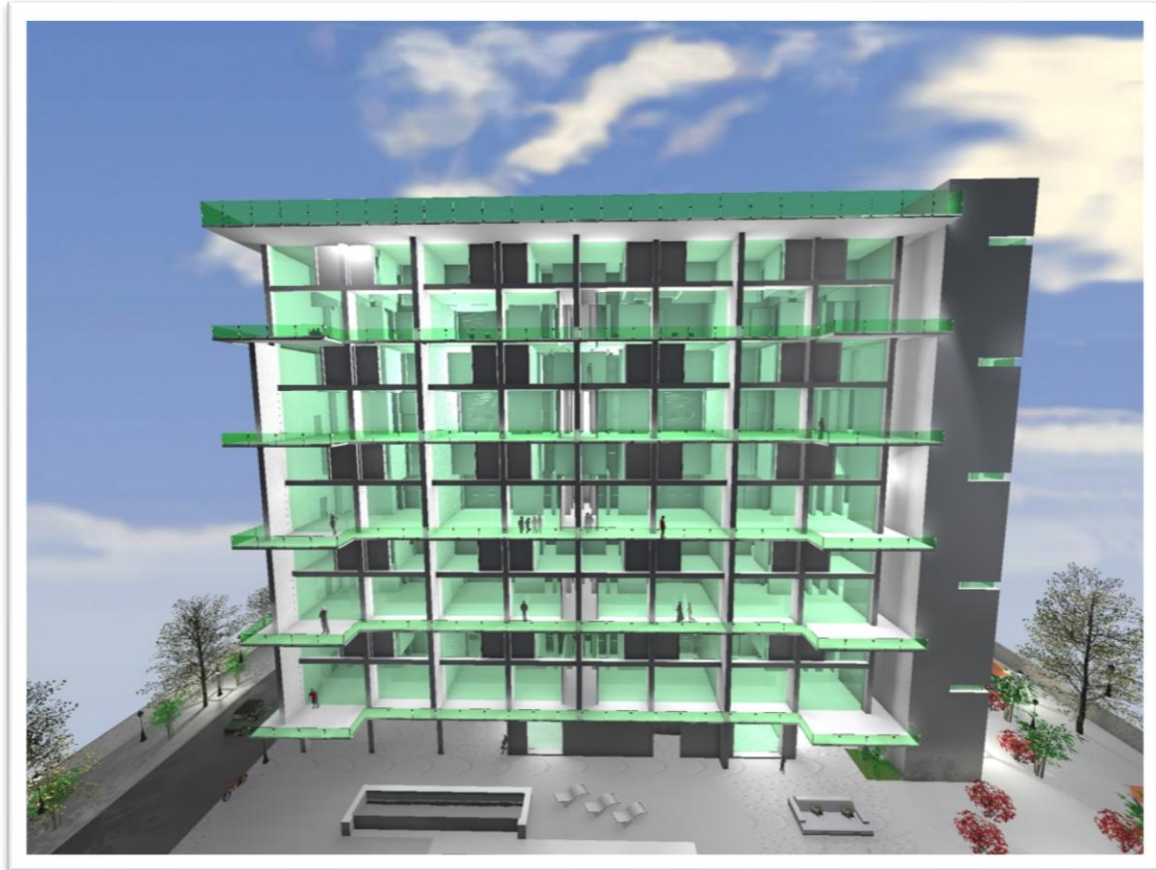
Fachada principal desde avenida trece. Fuente: ALJC.
